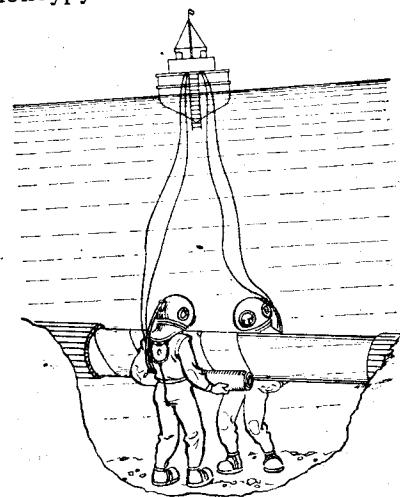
Наложение изоляционного бинта на трубопровод под водой
